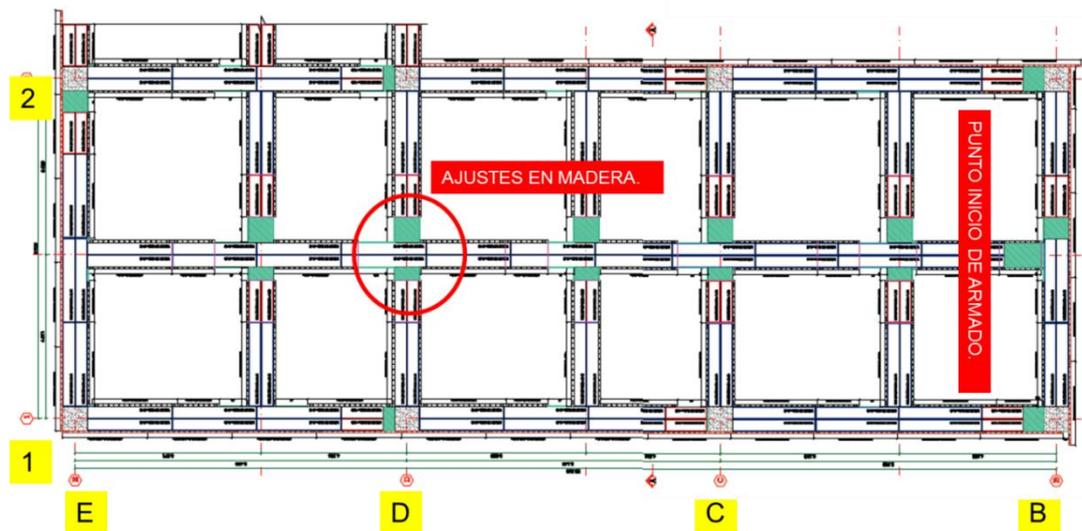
Vista en planta distribución de andamios en la losa entre piso
